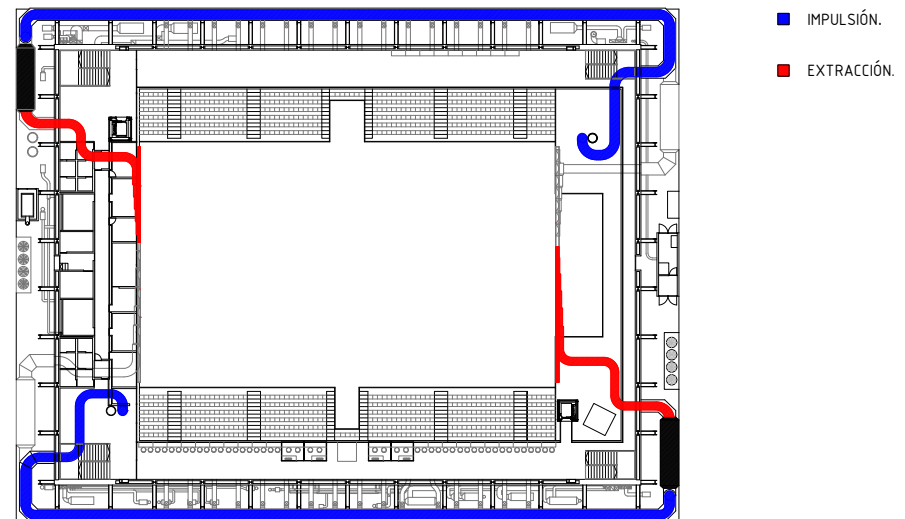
Detalle da impulsión de HVAC na planta primeira. Escala 1/100.
